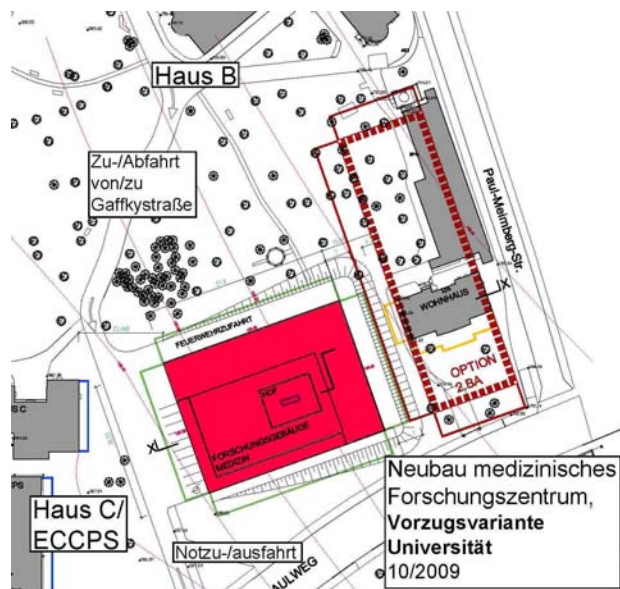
Bauherren-Vorzugsvariante „Kompaktbaukörper“ mit Abstandsflächen, Zufahrten und 2. BA
